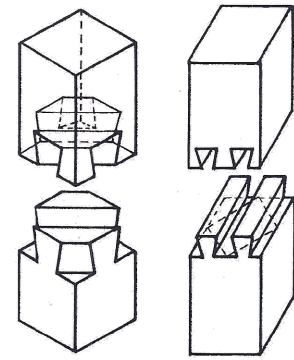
Ensamblajes de cola de milano sencilla y la doble espiga falciforme
